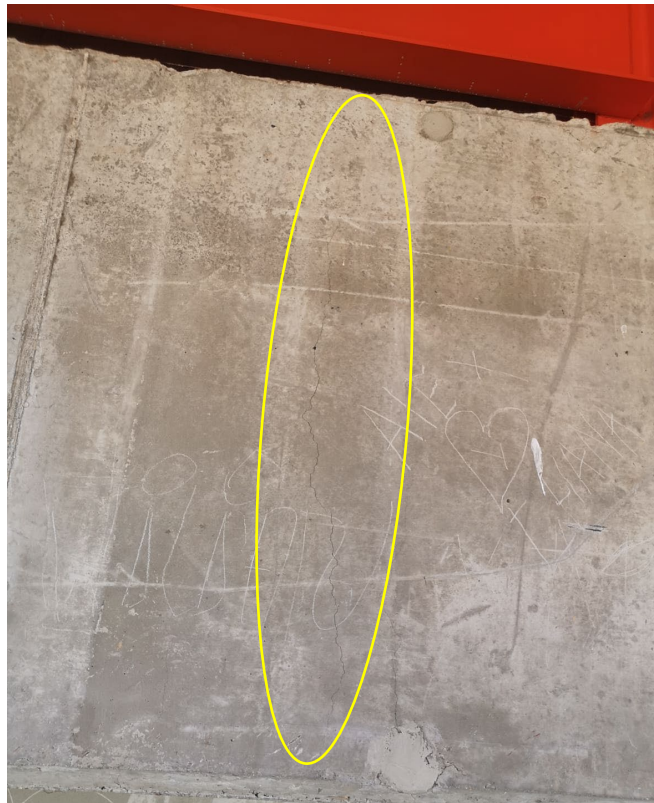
Fisura en el estribo izquierdo de del puente Malcas
